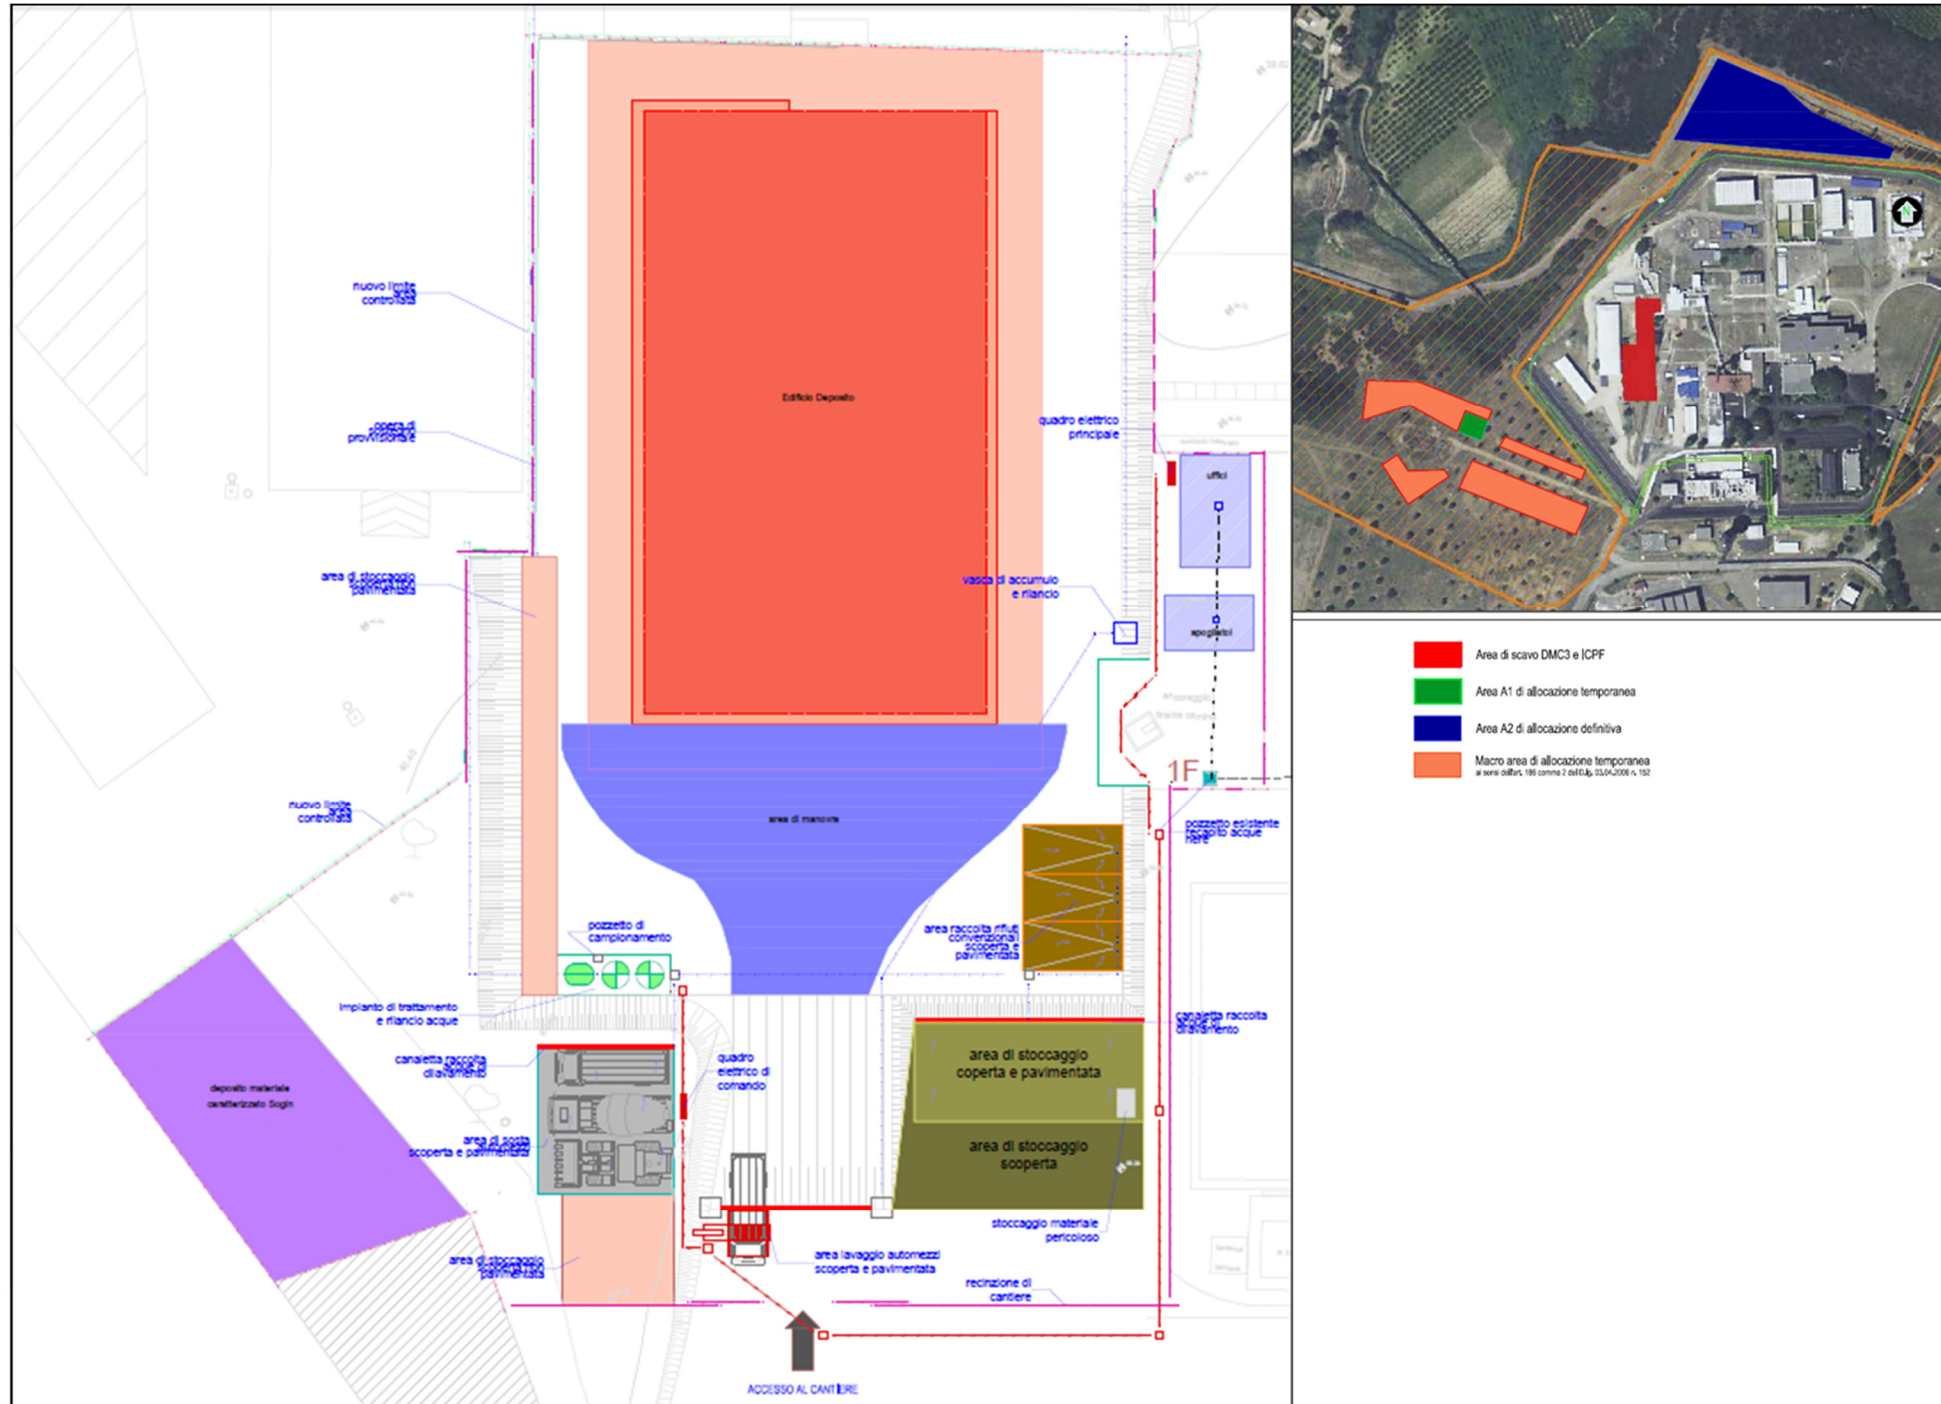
/1 -- Planimetria area di cantiere (IT PF 00072_rev02)
